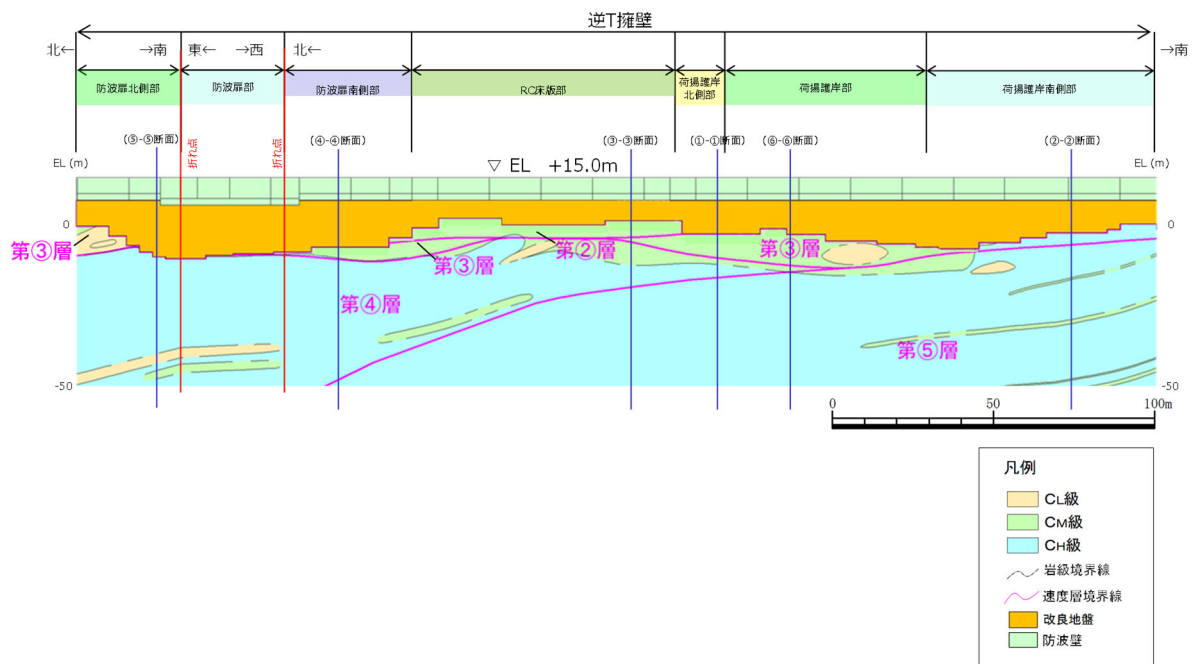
防波壁（逆 T 擁壁）の縦断面図
